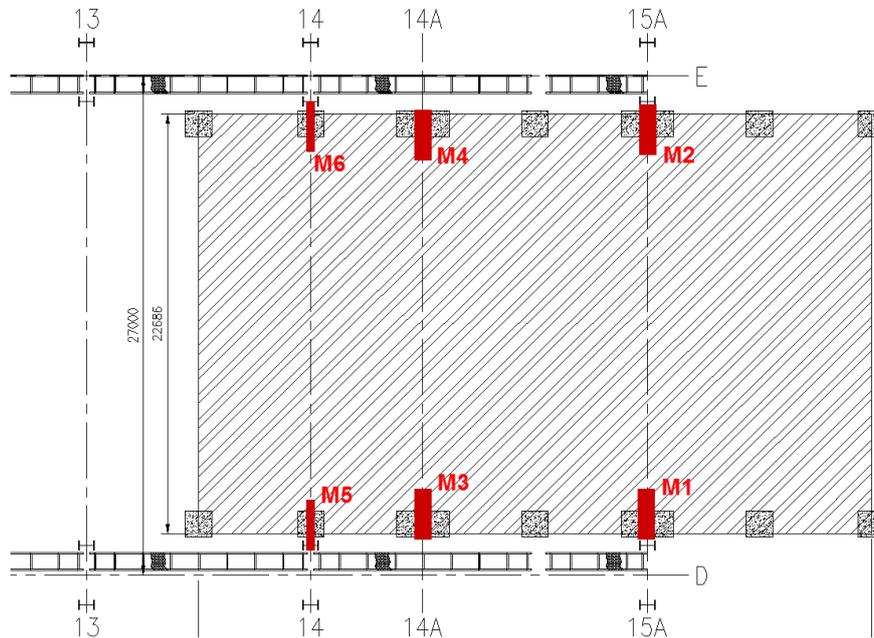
Ubicación en planta las de ménsulas de tope y deslizamiento.
